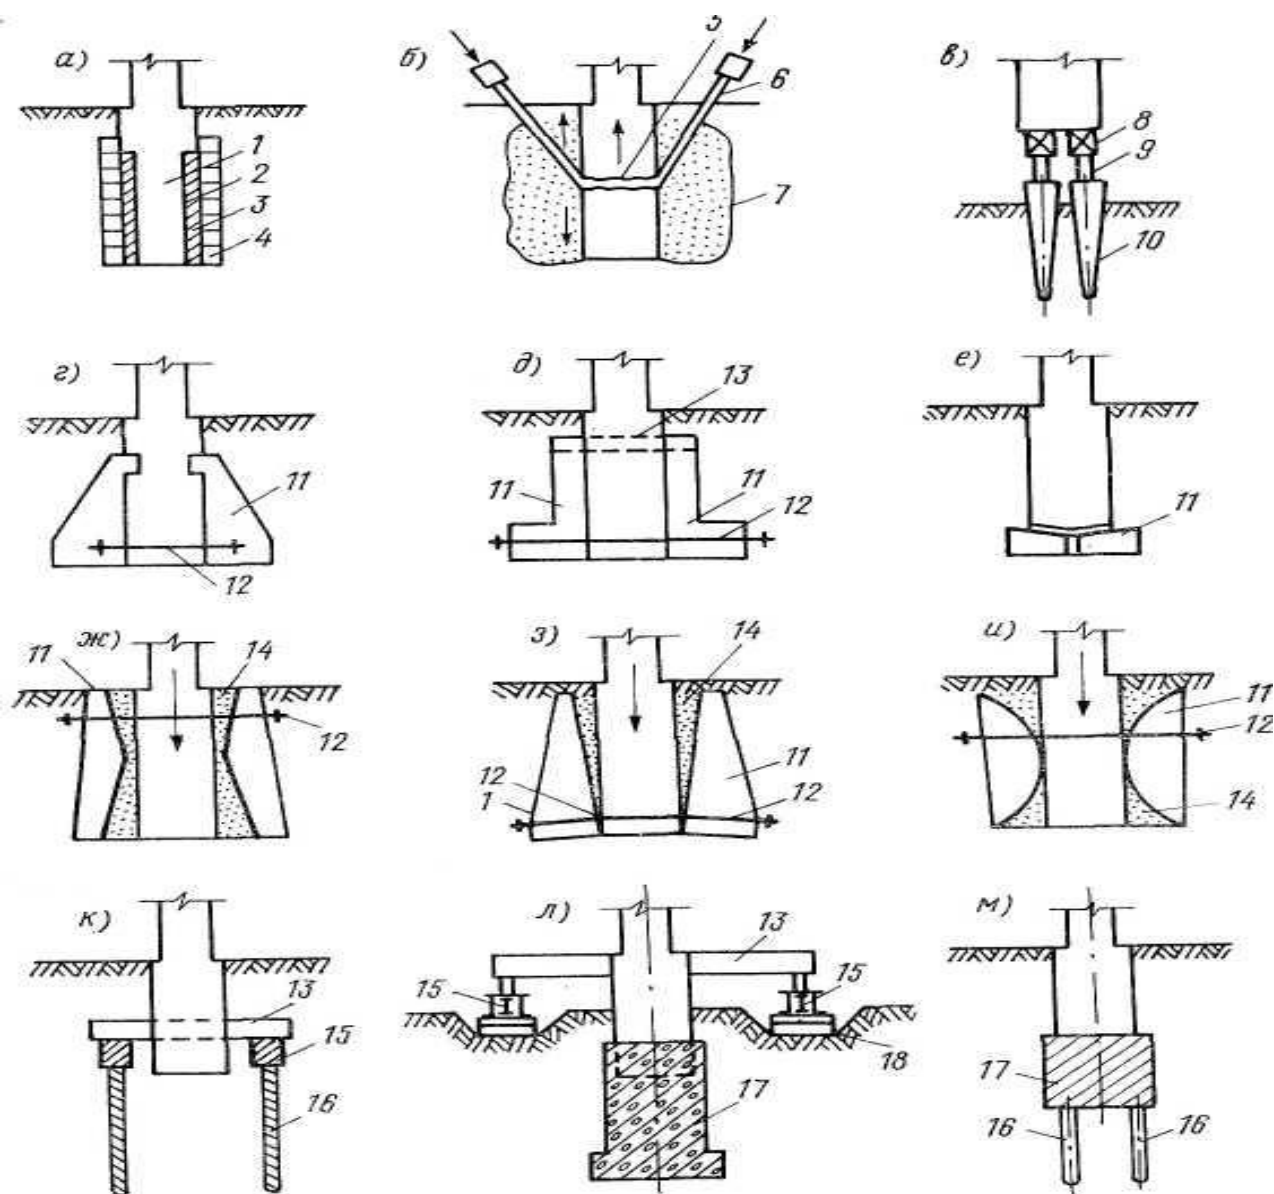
Передача нагрузки на нижележащие слои грунта раствора в разрыв при морозном пучении; в – путем подведения свай; г, д, е, ж, з, и – уширение подошвы с помощью железобетонных приливов и стальных тяжей; к, л, м – под основания балки: 1 – торкрет-бетон; 2 – изоляция; 3 и 4 – защитная стенка; 5 – разрыв фундамента 6 – иньектор; 7 – уплотненный грунт; 8 и 9 – балки; 10 – сваи; 11 – железобетонные приливы; 12 – стальной тяж, 13 – поперечная балка; 14 и 15 – продольные балки; 16 – сваи; 17 – дополнительный фундамент; 18 – основание под балки
